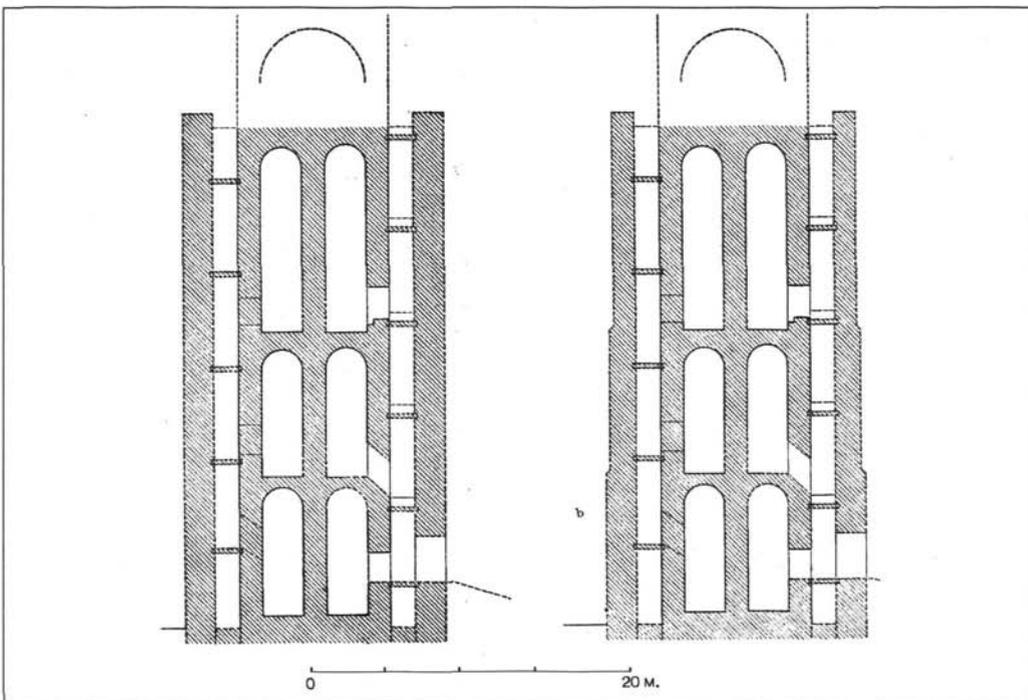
Hipotética reconstrucción del faro de Brigantium con dos posibilidades: a/ muro ext. liso o b/ muro ext. escalonado (Hauschild, 1977, 149-150, fig. 15).
